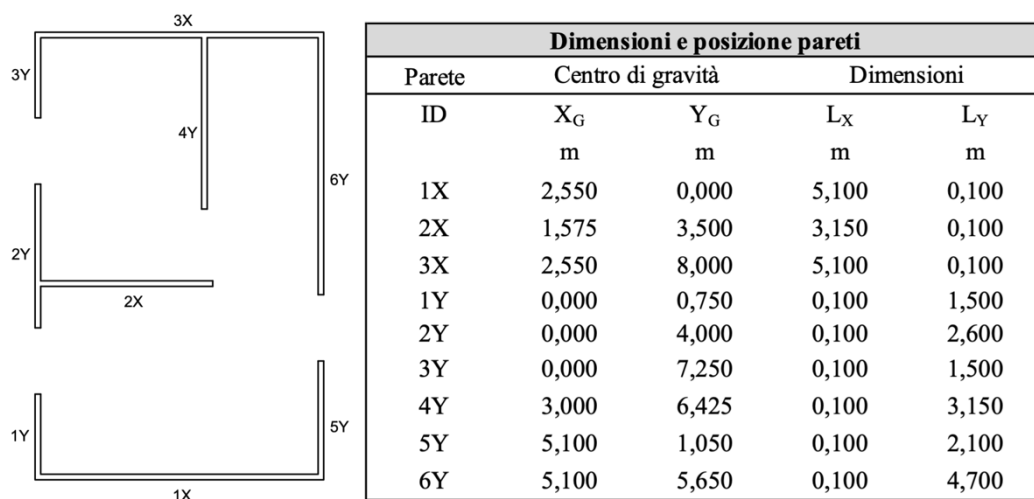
a) Pianta della struttura oggetto di studio b) Dimensioni e posizione delle pareti della struttura
